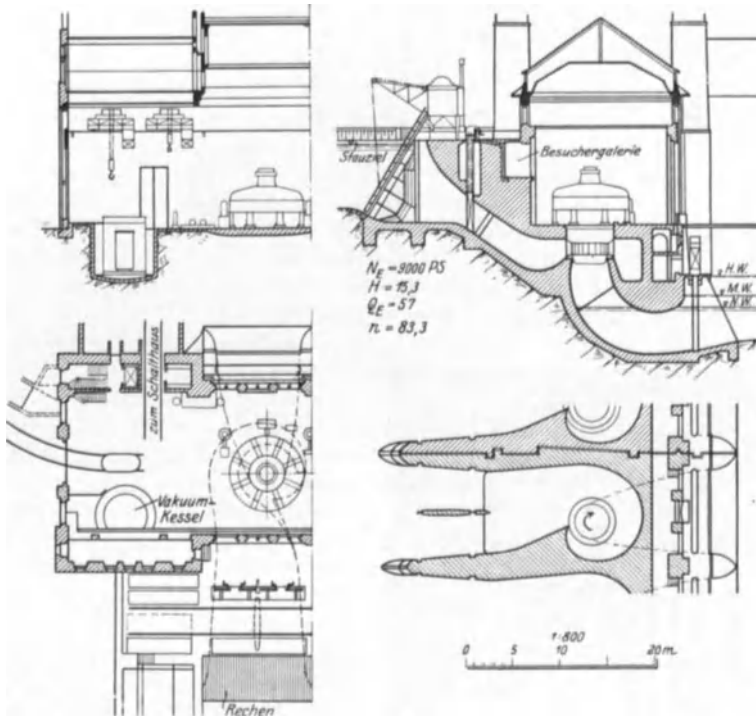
Olten-Gösgen, Grundrisse, Quer- und Längsschnitt mit Transformatorgrube.
